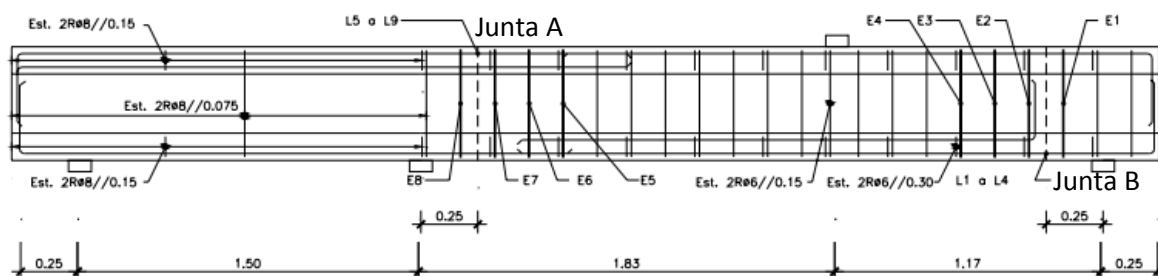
Localização dos extensómetros nas armaduras transversais e longitudinais, extraído de Cavaco [26]
